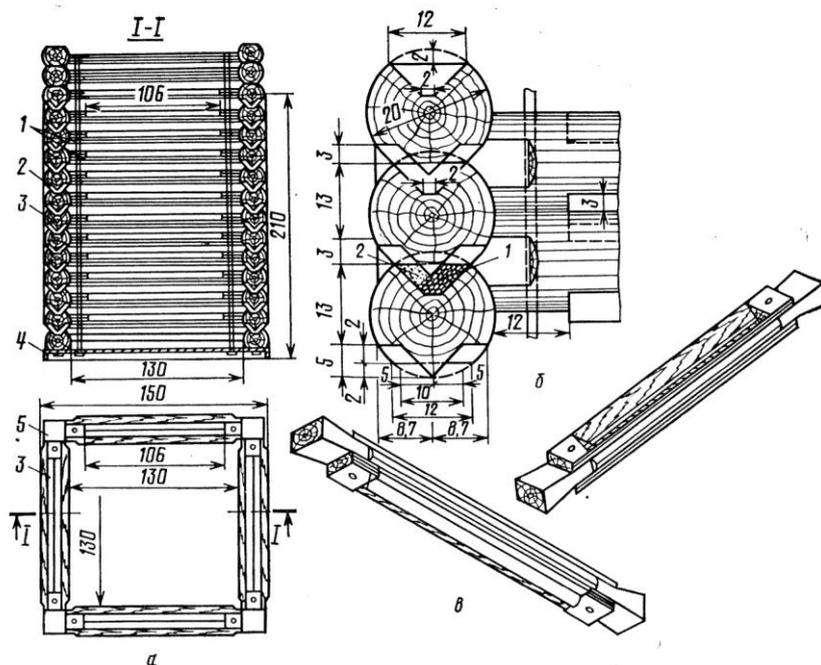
Колодезный гравитационный фильтр (бревенчатая конструкция) *а* – план и разрез; *б* – деталь боковой стенки фильтра; *в* – деталь венца фильтра
